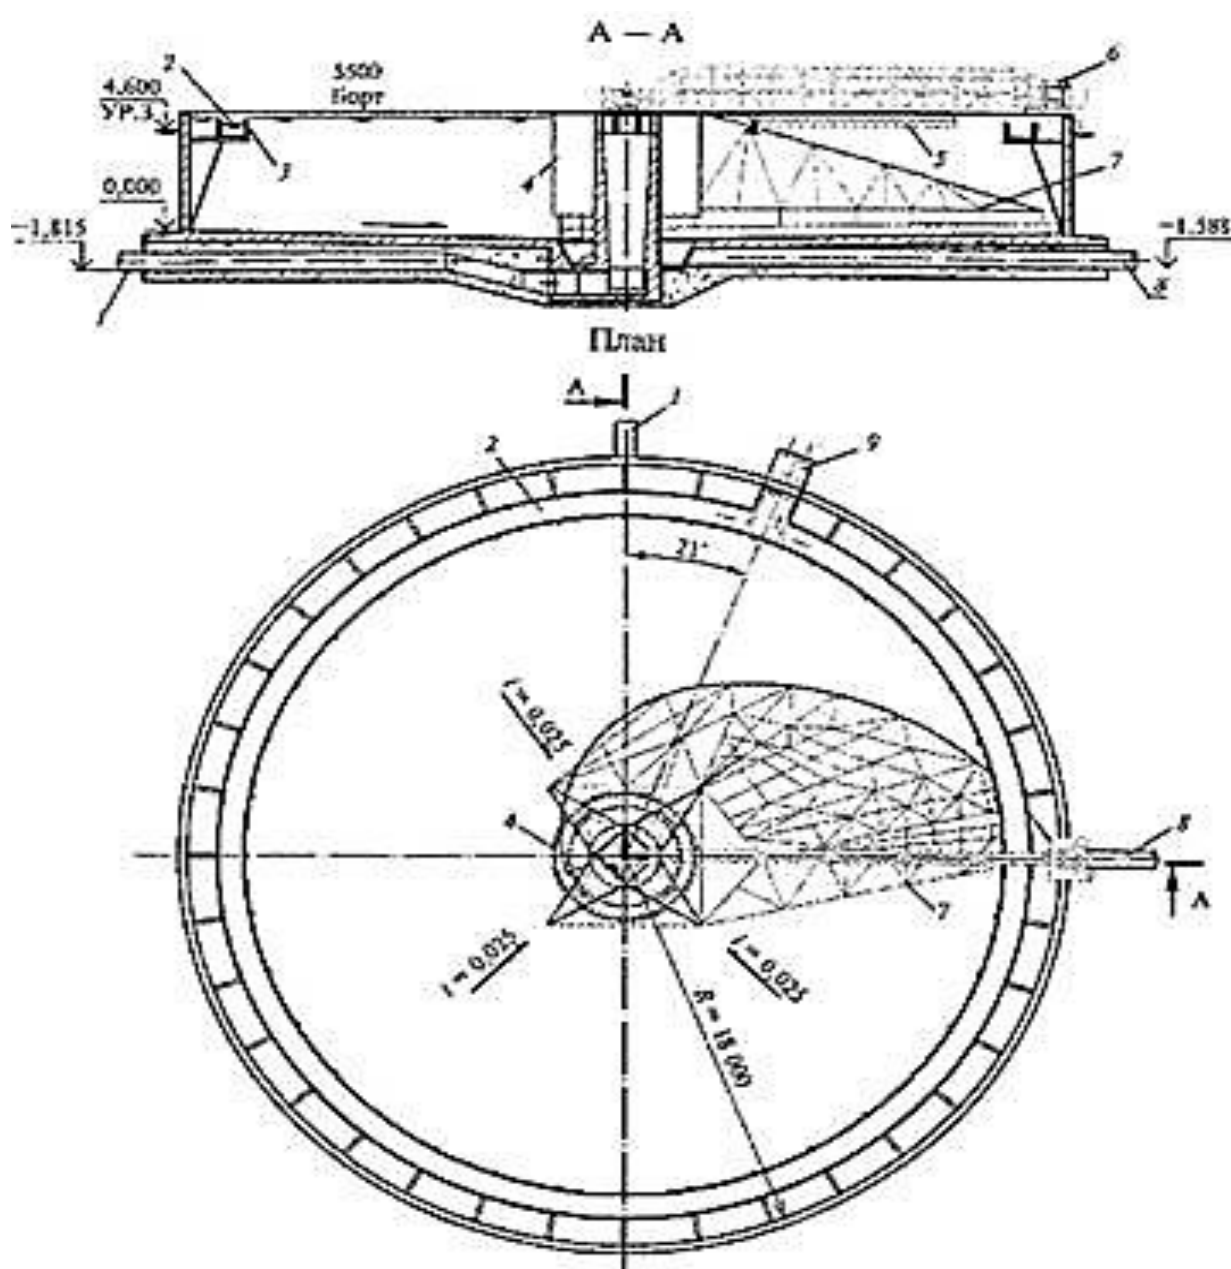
Схема вторичного отстойника с устройством эвольвентными-лоскреб:
